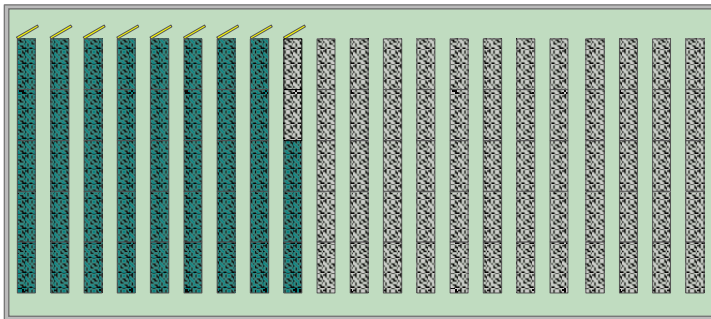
Dachaufsicht mit PV-Anlage | EG 40EE (grün) und optionale Flächen (grau)
